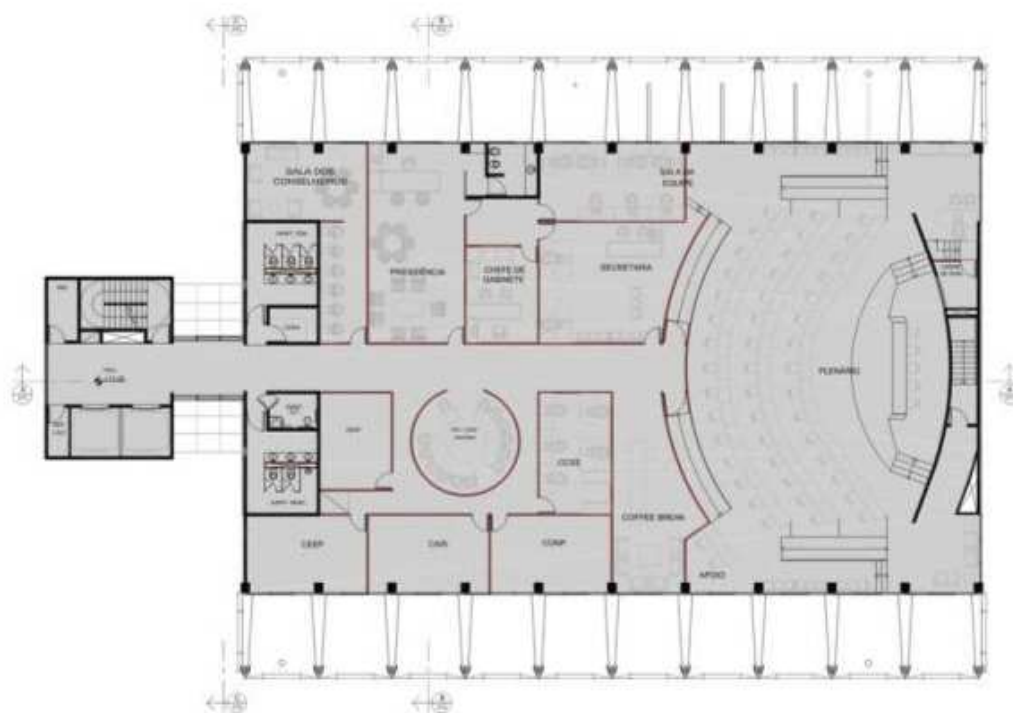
Planta Baixa | 4ª Pavimento. (FONTE: SKYSCRAPERS, 2011).
